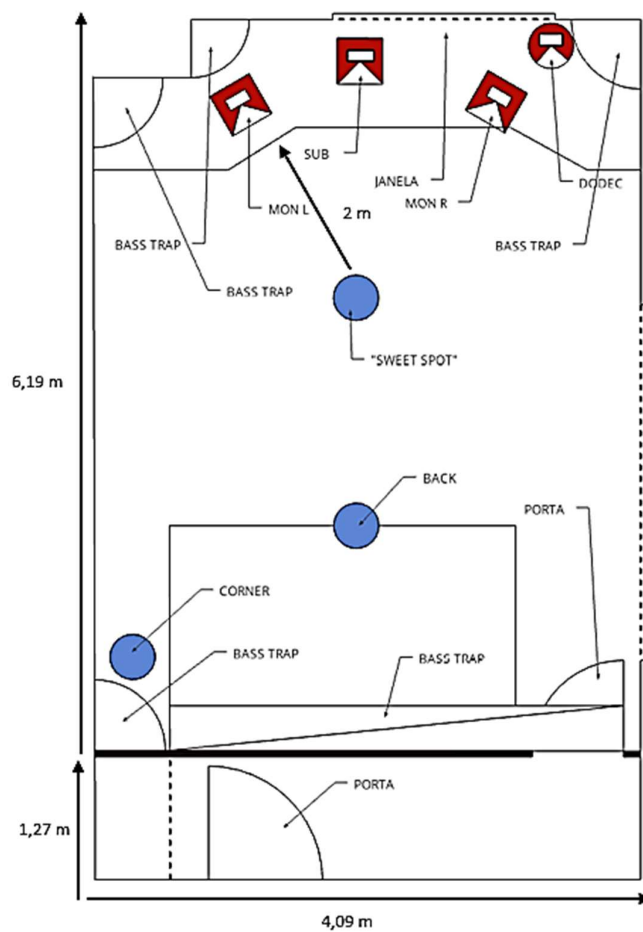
Visão em planta da sala “ESMAE – Régia A”
